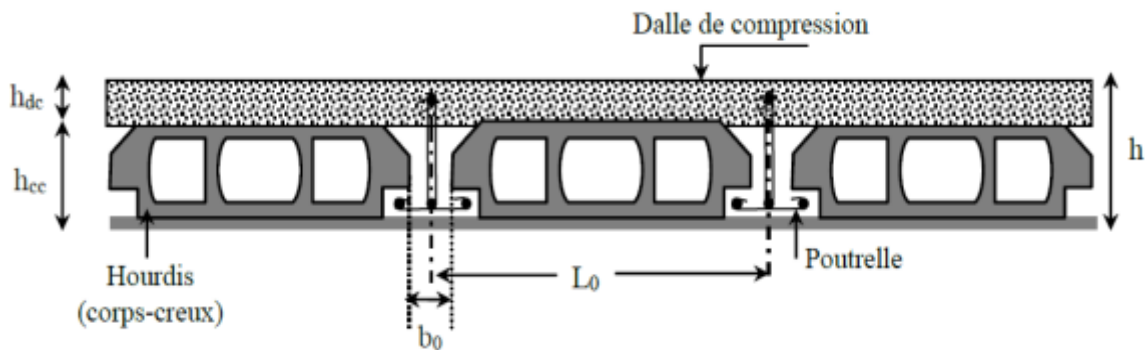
Coupe transversale d'un plancher à corps creux.
